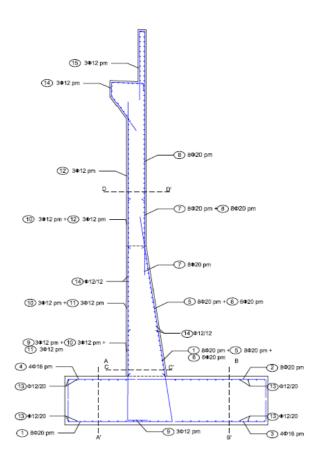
Armado del estribo de Portugal (Fuente: Propia)
